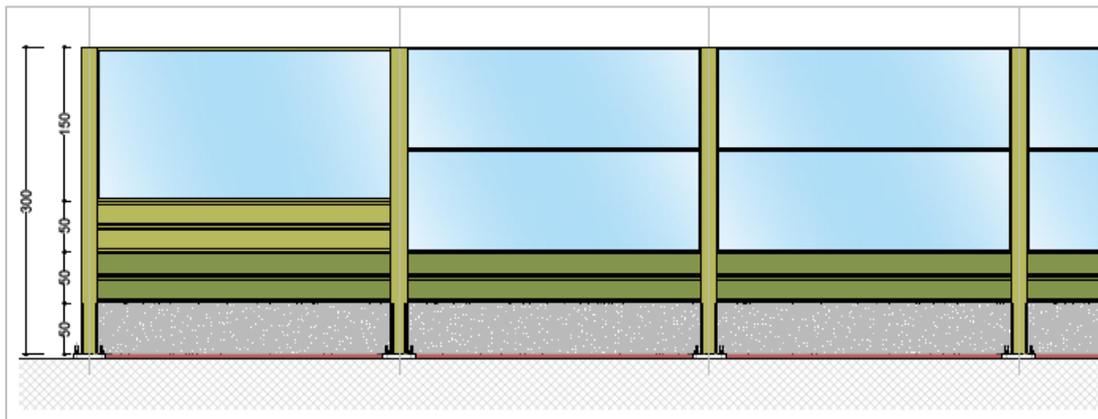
/1 Prospetto tipo Barriera n. 1 – La parte di altezza 2 metri con pannelli trasparenti corrisponde al tratto di maggiore prossimità ai ricettori
